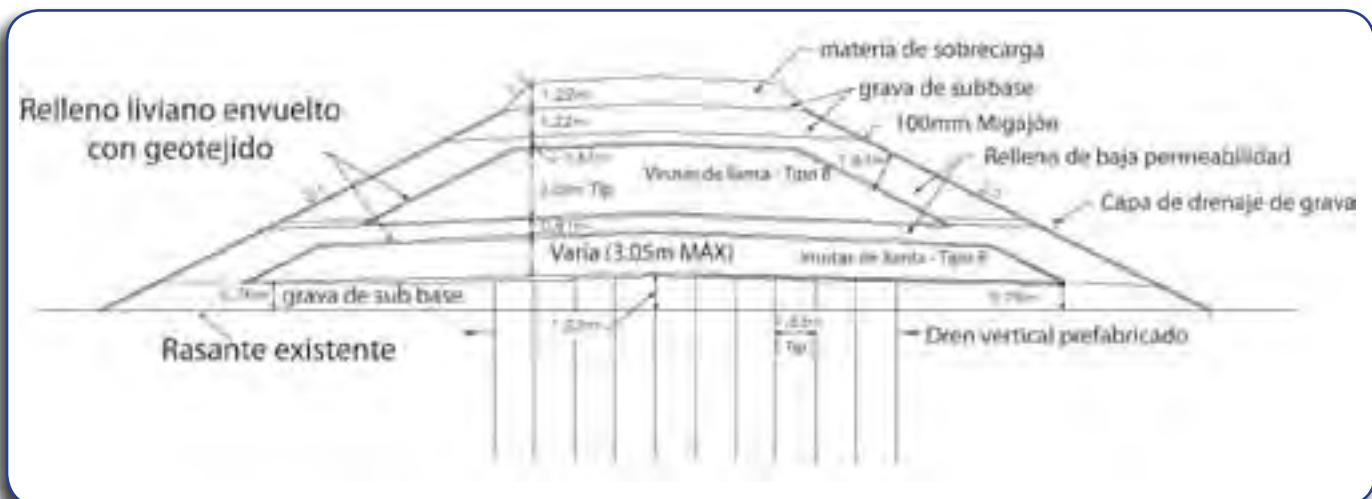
Corte transversal del terraplén construido de arcilla marina suave en el Intercambio Vial del Aeropuerto de Portland (Ref. 5).
